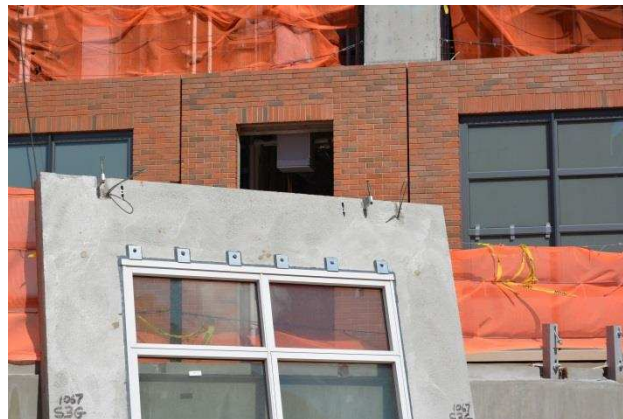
Detalhe do painel pré-fabricado utilizado para vedação. (ISSAC, 2016)
